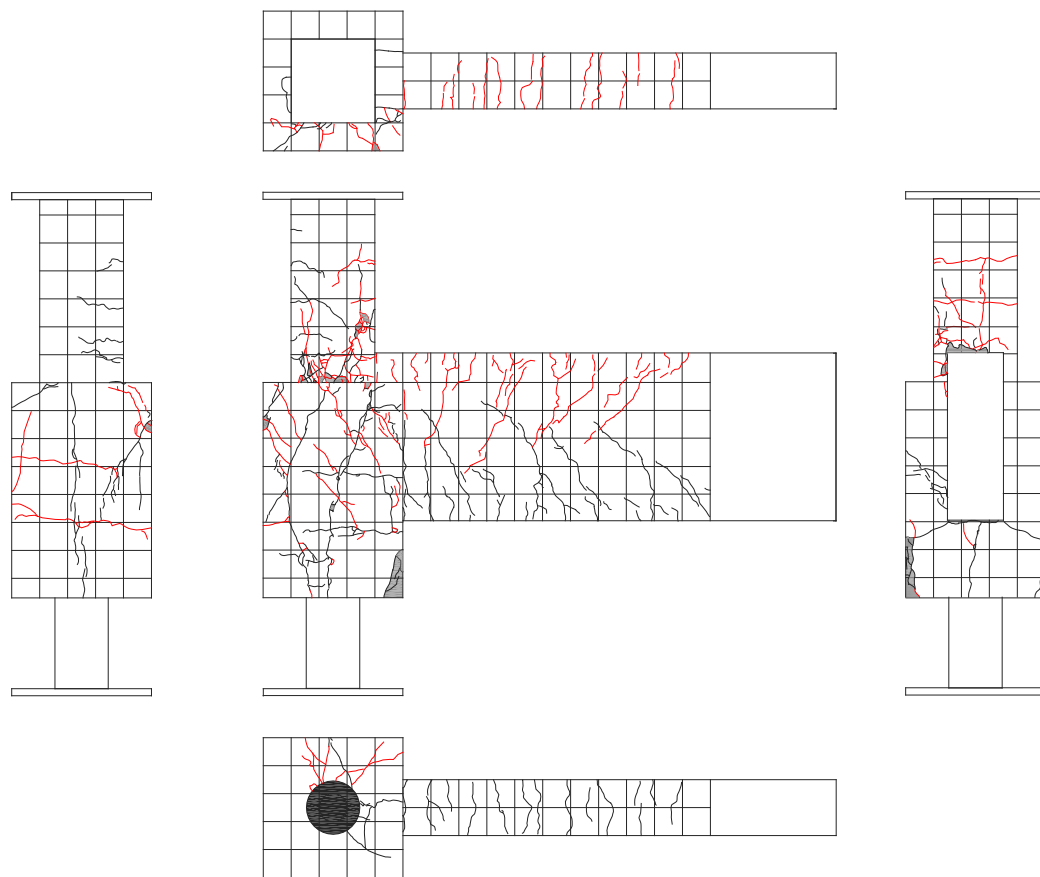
試験体 A-4 ひび割れ状況 (8Cycle)
